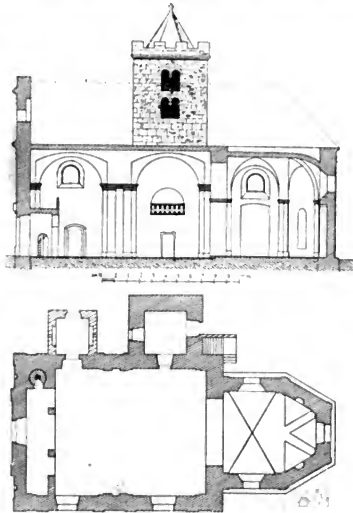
Čečelitz. Längendurchschnitt und Grundriss der Kirche.
